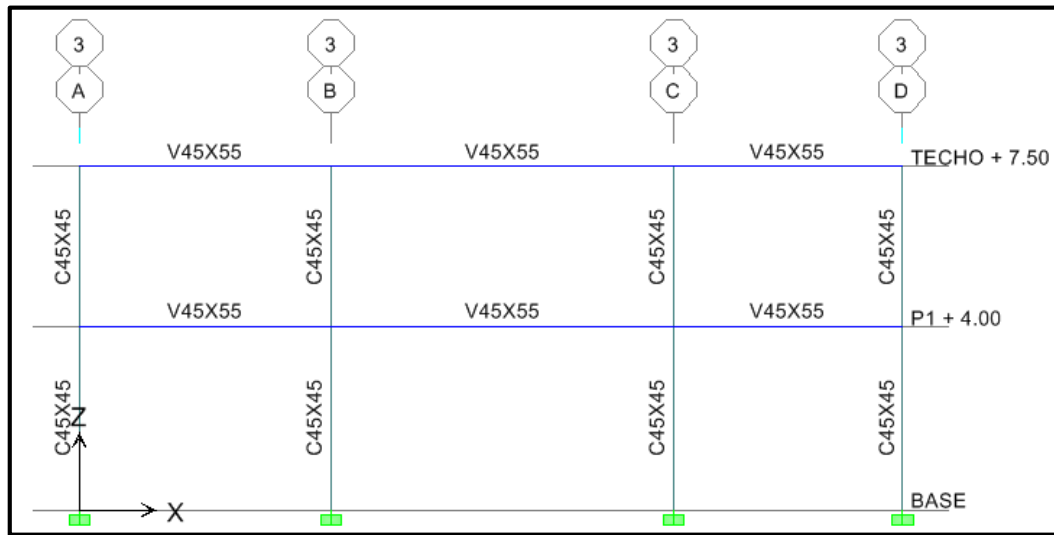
Secciones Finales de Columnas (Pórtico 3)
